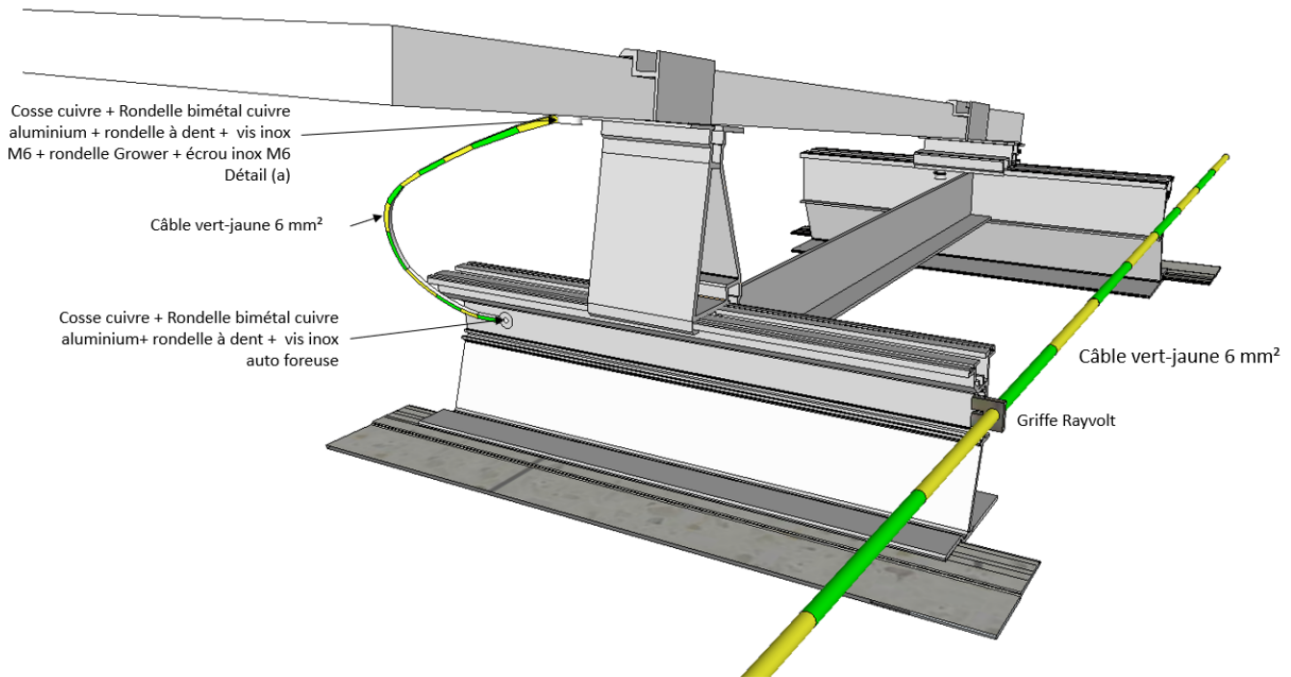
Exemple de plan de câblage des modules photovoltaïques et maintien des câbles
